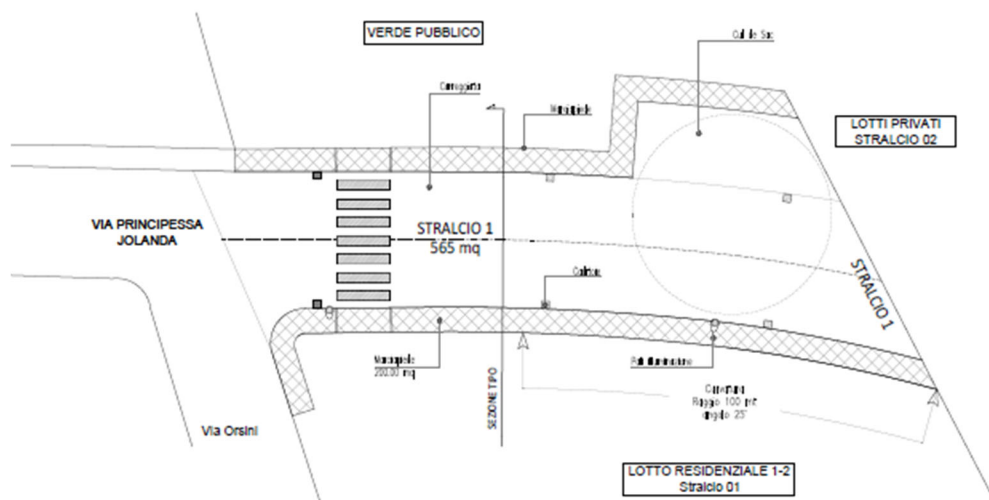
Planimetria sistemazione Via Principessa Jolanda
